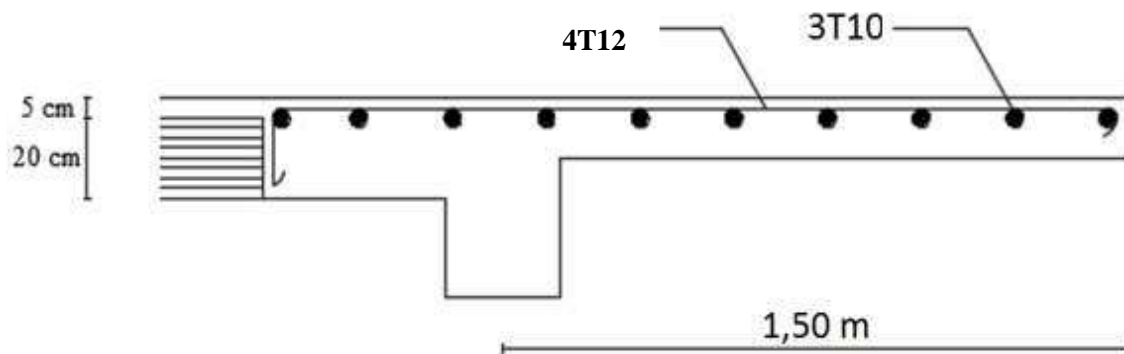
Ferrailage de la dalle pleine balcon de Type 1
